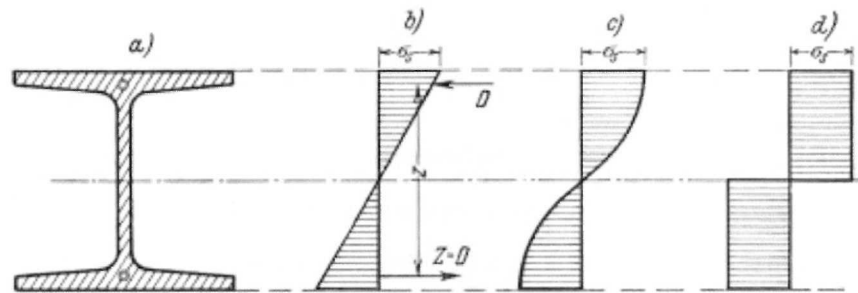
Distribución de esfuerzos en vigas según Maier-Leibnitz²². a) Sección transversal b) Estado en el límite elástico c) Estado parcialmente plástico d) Estado completamente plástico.
